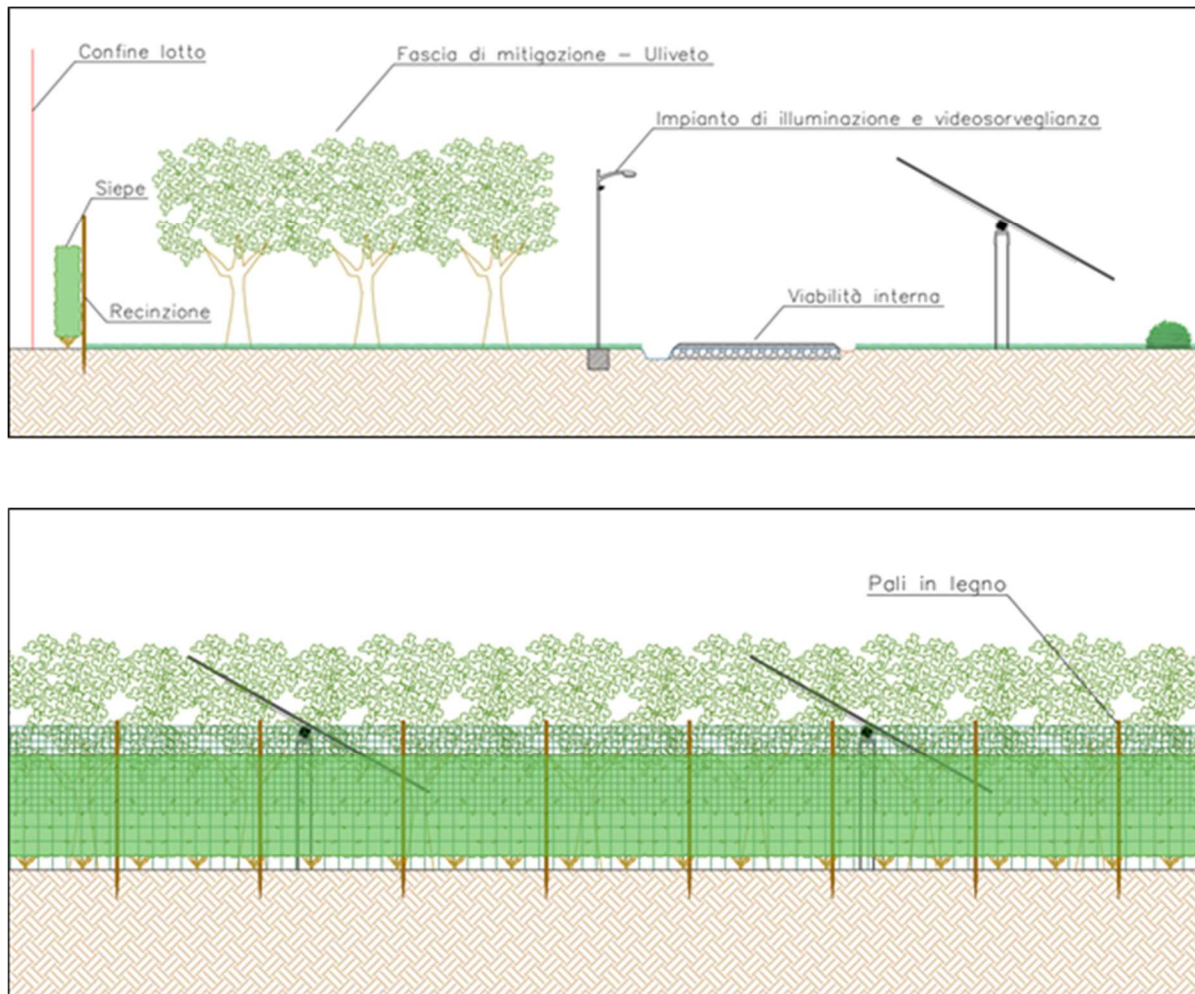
Fascia di mitigazione tipo -sezione viabilità interna e prospetto recinzione
